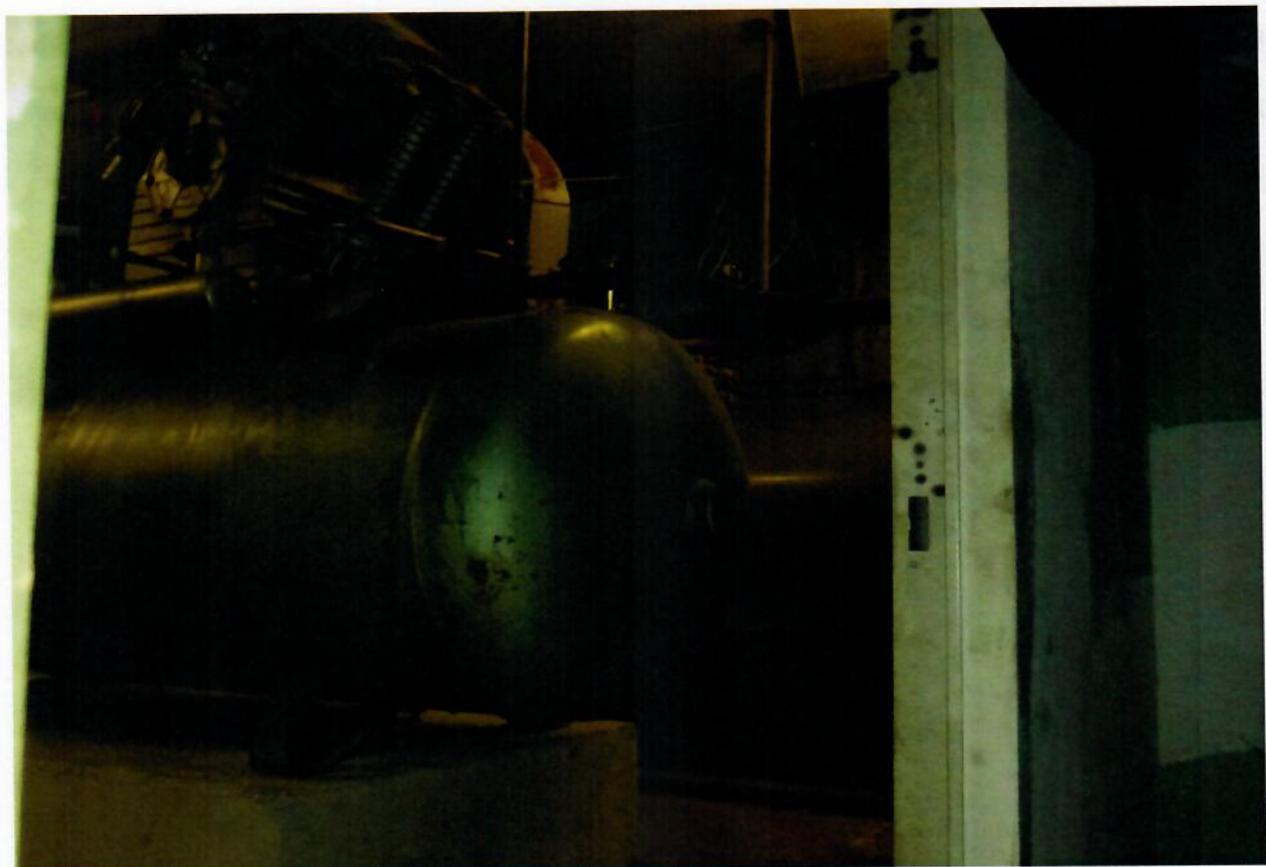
Sonstige Technik 15: Druckluftanlage, Wellenbecken
